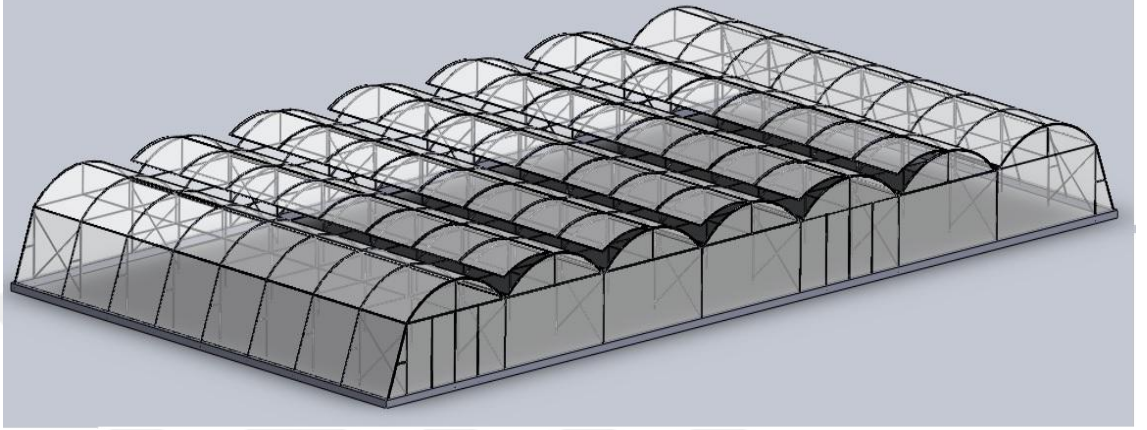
Sera taban alanı cihaz yerleşim planı
